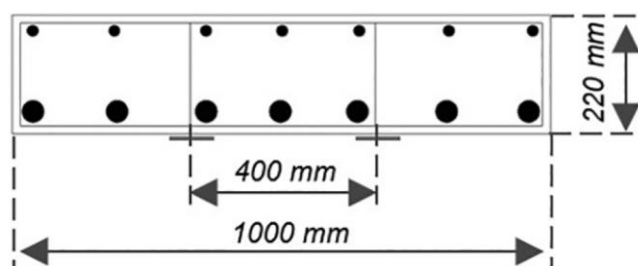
Sección transversal de las vigas [Garcez M.R., L.C. Meneghetti, R. M. Teixeira (2019)]
